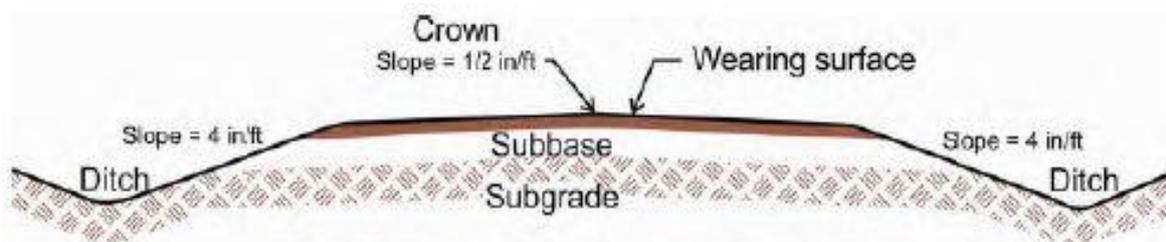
SEZIONE DI UNA PISTA DI CARREGGIO DI CANTIERE (NIOH)
